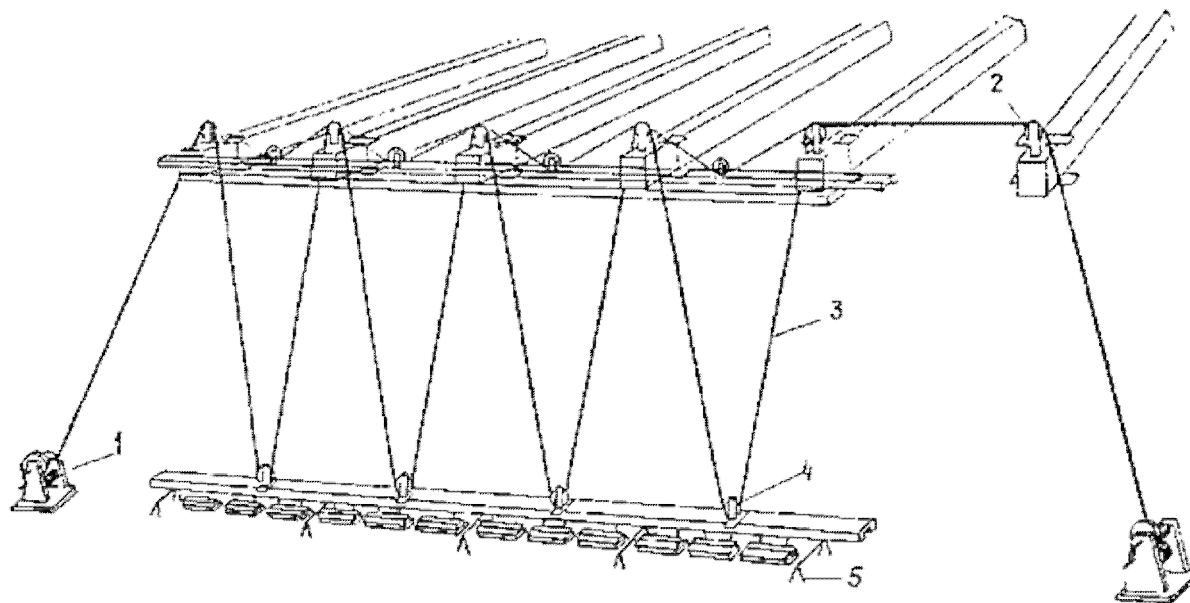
Схема подъема коробов с люминесцентными светильниками, собранных в линию длиной до 24 м: 1 - лебедка; 2 - инвентарные ролики на конструкциях; 3 - трос диаметром 6 мм; 4 - инвентарные ролики на коробах; 5 - козлы металлические для сборки секций коробов и подвески к ним светильников
